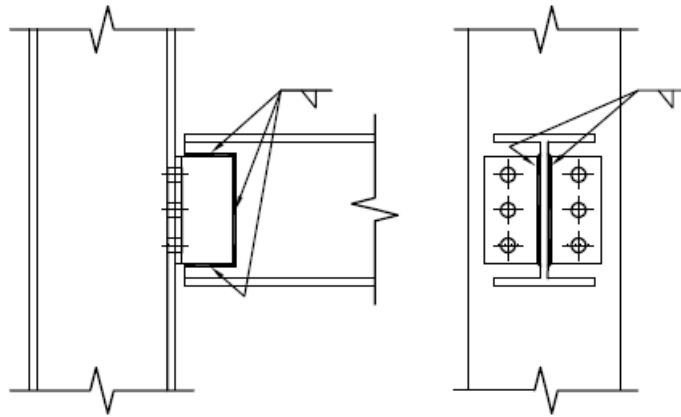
ligação flexível com duas cantoneiras soldadas na alma da viga
